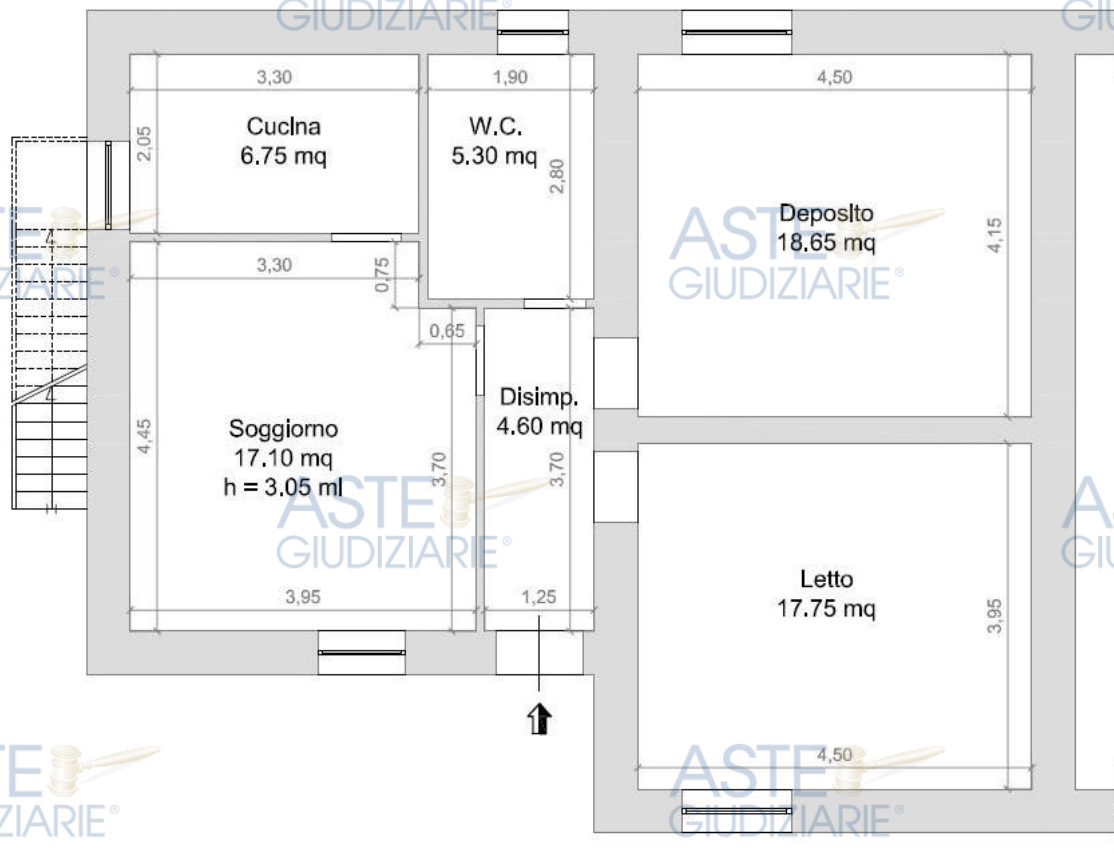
Planimetria Stato di Fatto Piano Terra Foglio 31, p.lla 1253.
